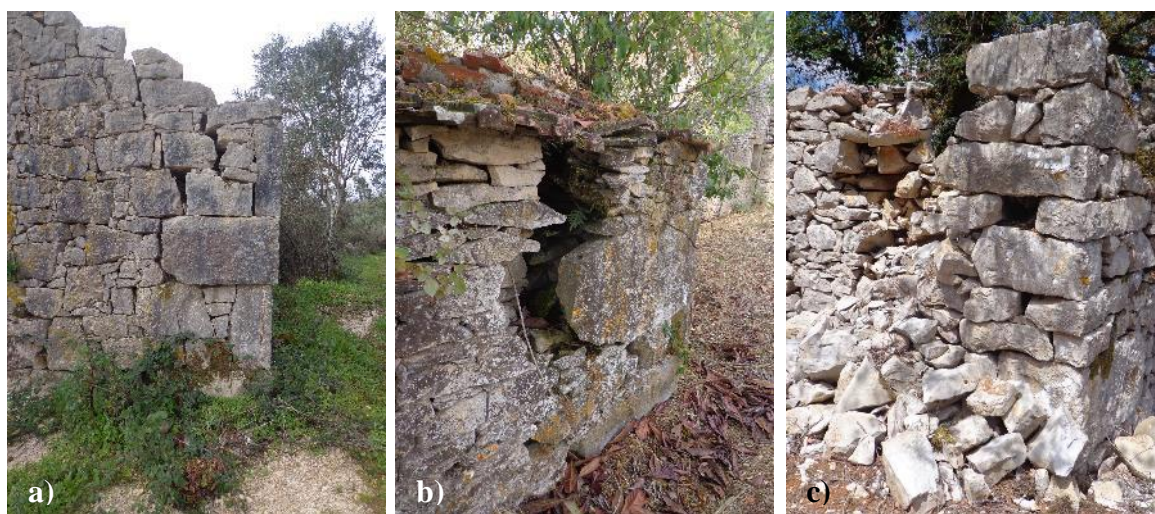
Deficiente ligação em zonas de cumbramentos: a) Fissura vertical por induzida por rotação para fora do plano; b) Desligamento de entre elementos em zona de cumbral com fenda acentuada; c) Colapso da estrutura de alvenaria por falta de ligação entre elementos.
